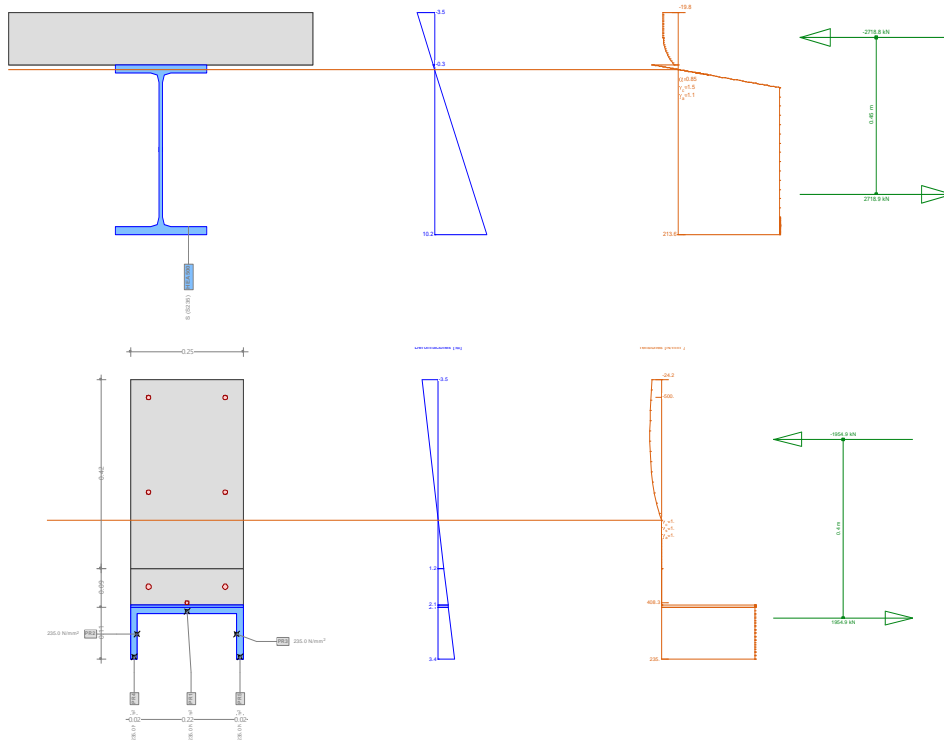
Sección mixta habitual en obra nueva (con eje neutro en ala superior del perfil), y técnica de refuerzo anexando semisección completamente traccionada.
